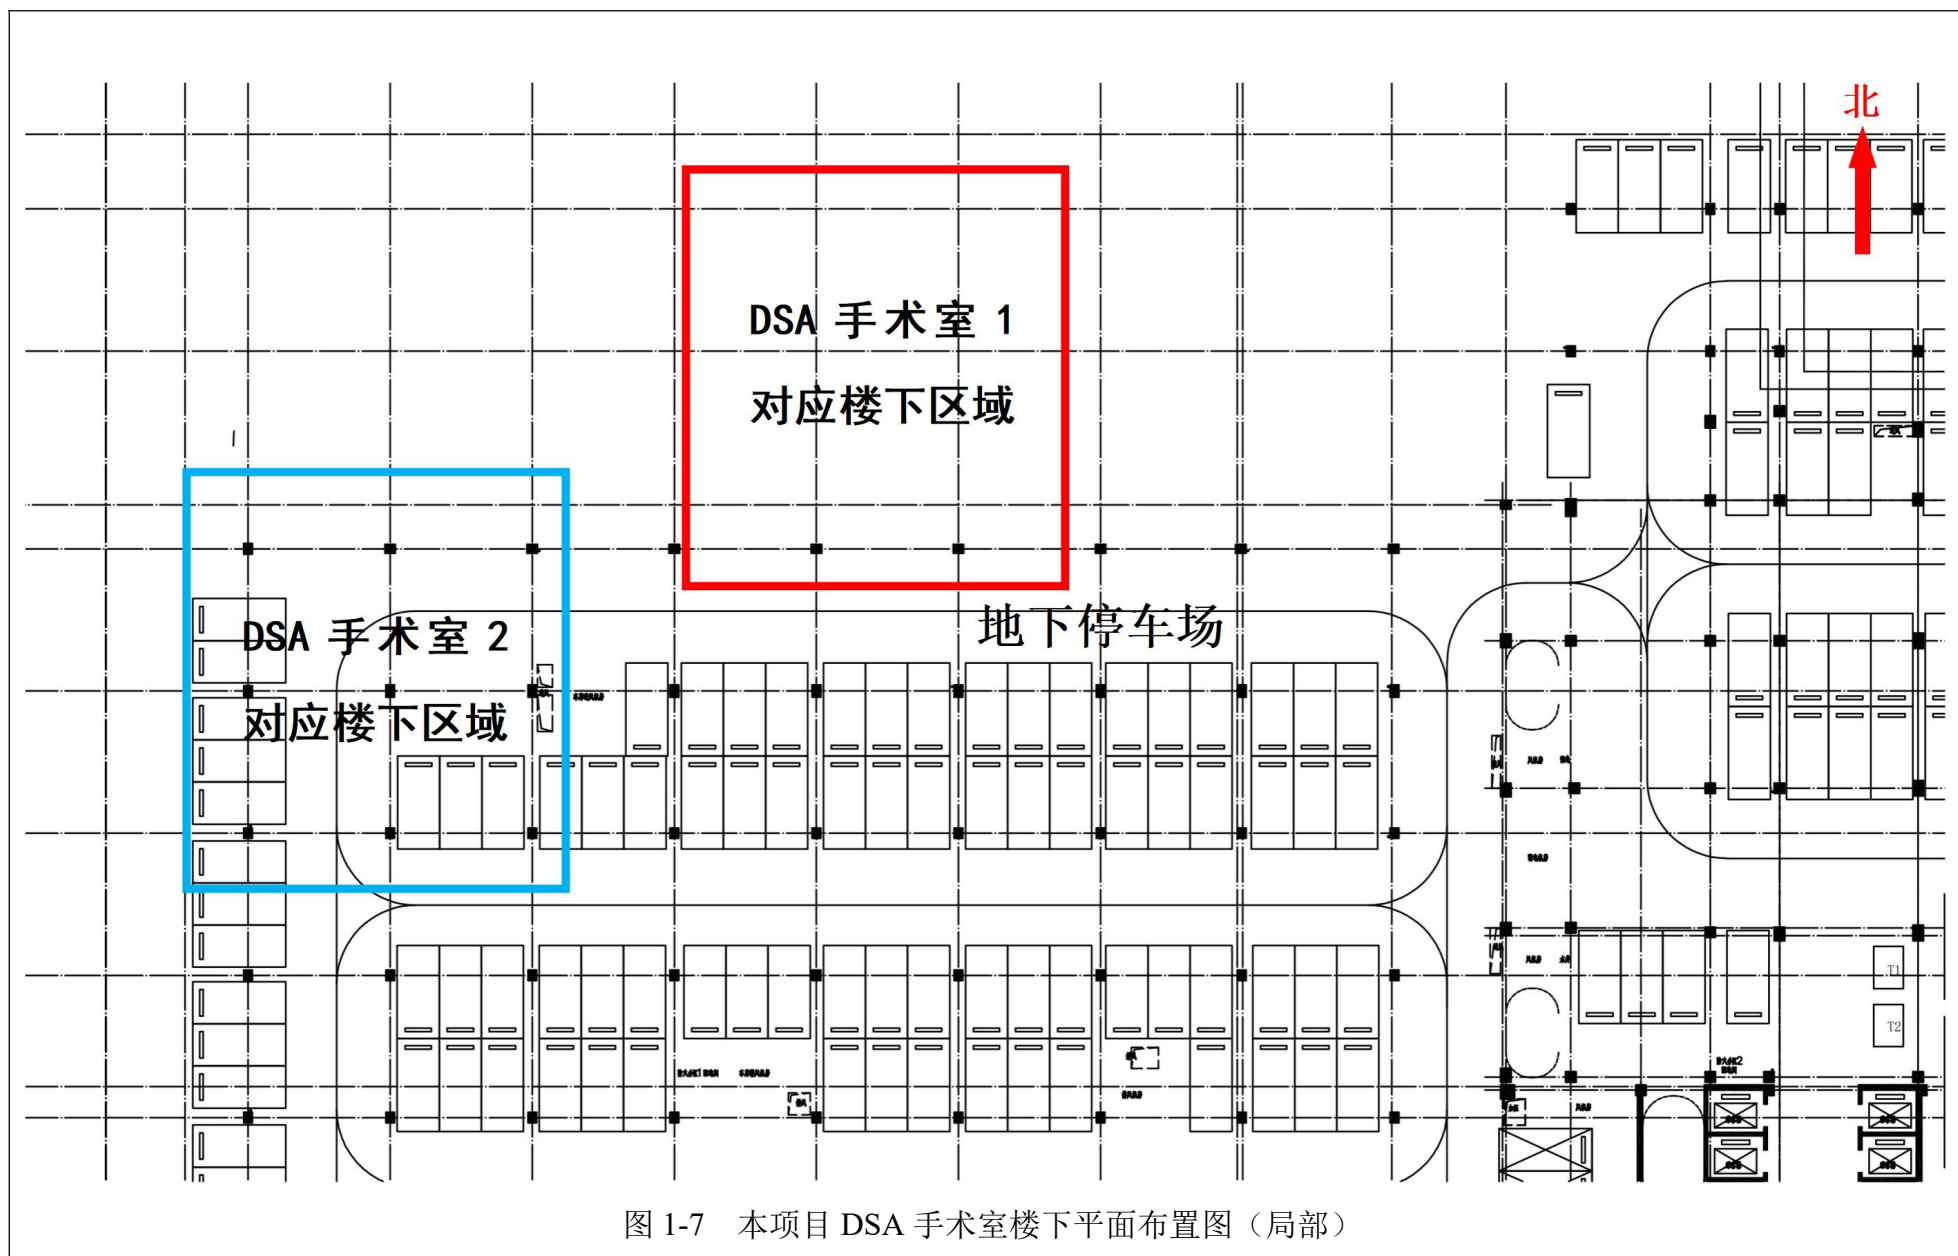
本项目 DSA 手术室楼下平面布置图（局部）
